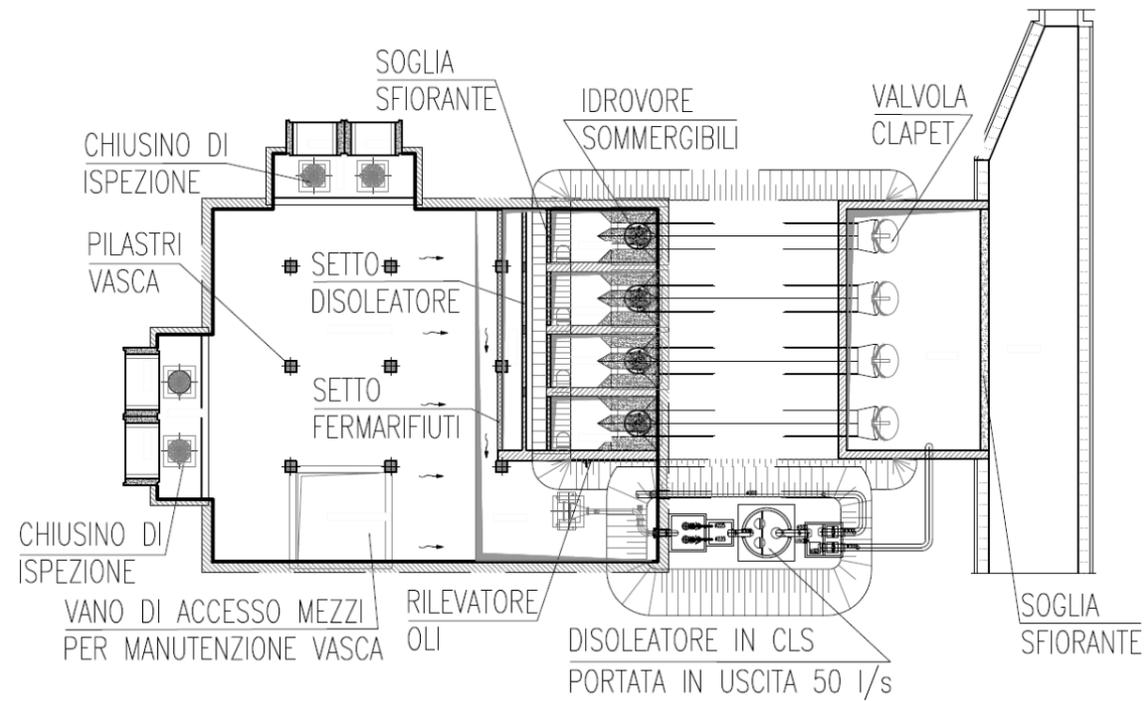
Planimetria vasca Piazzali di Espansione Est dell'Apron
